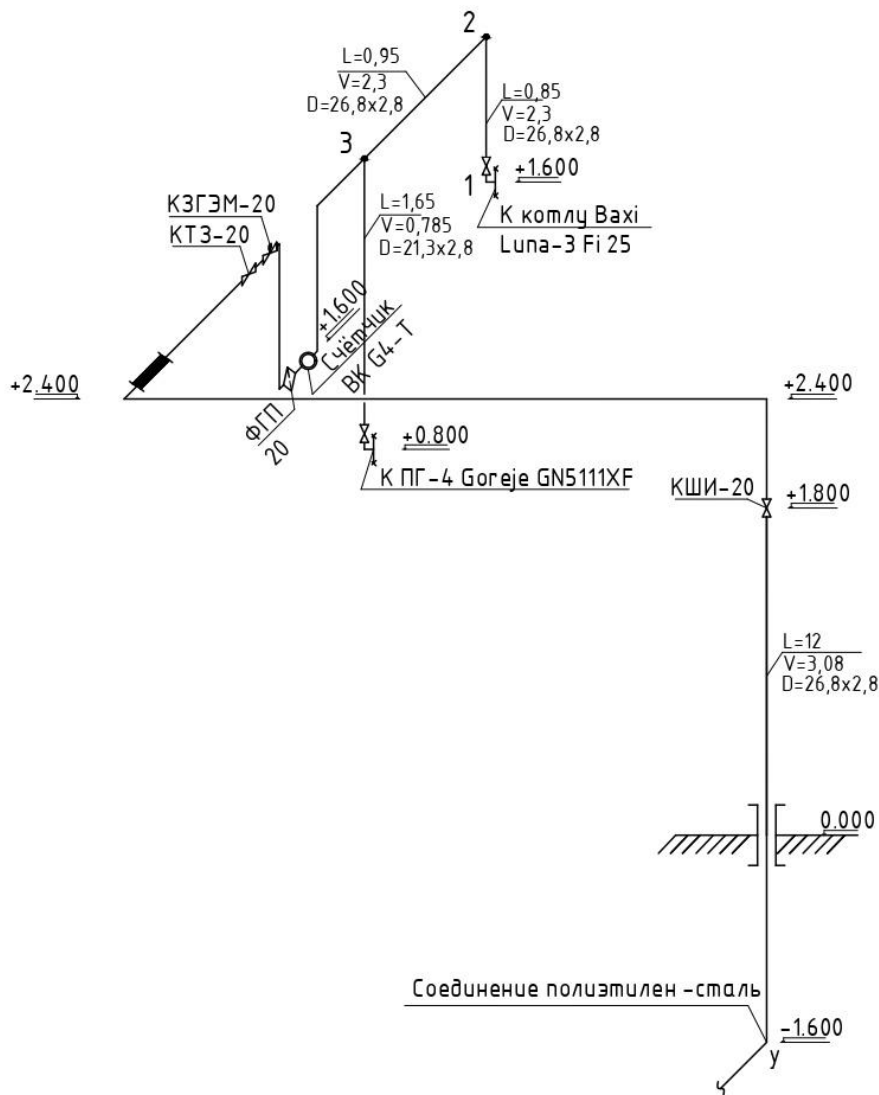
Расчетная схема внутридомового газопровода
